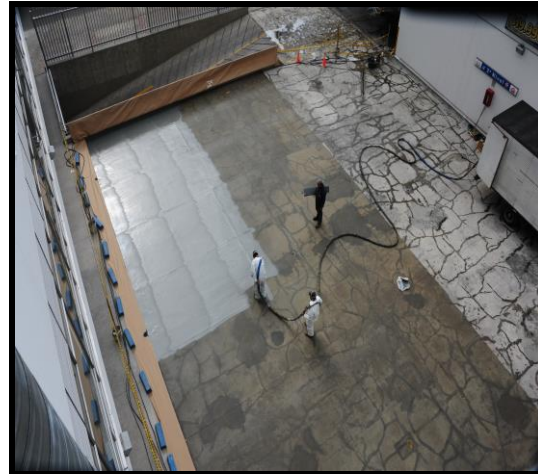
Aplicación de la POLIUREA TIPO ELASTOCOAT en un espesor de 80 mils con equipo mecánico tipo Graco.
